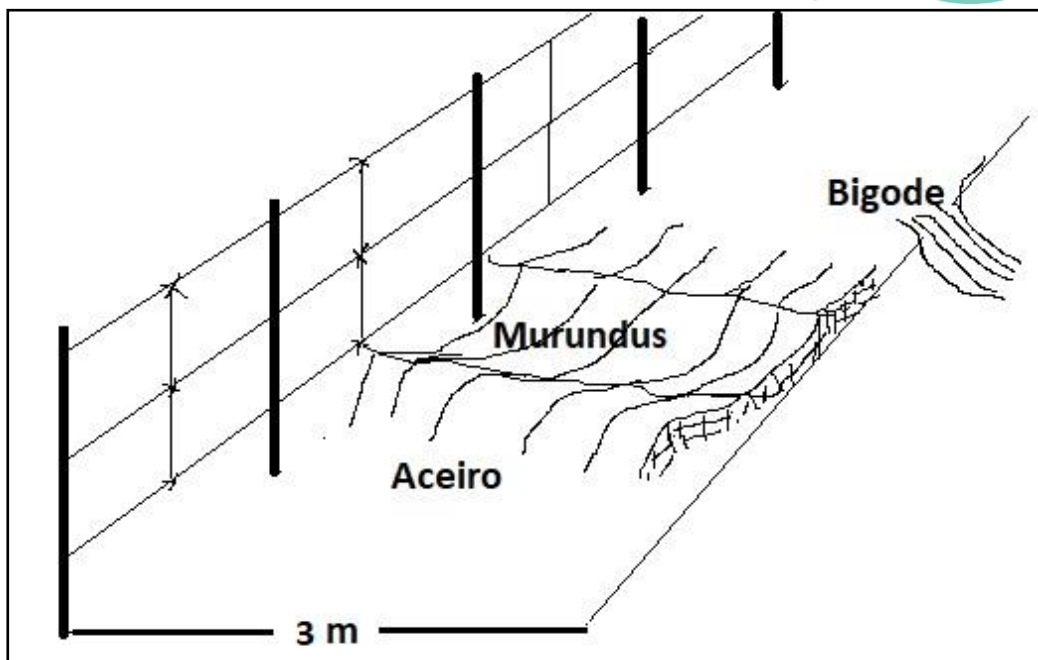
Desenho esquemático do aceiro e estruturas de controle da erosão (sem escala).
